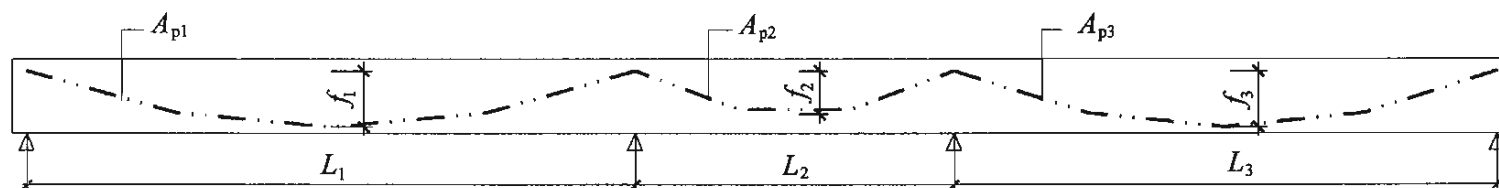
连续结构跨度差异较大时预应力束的调整
